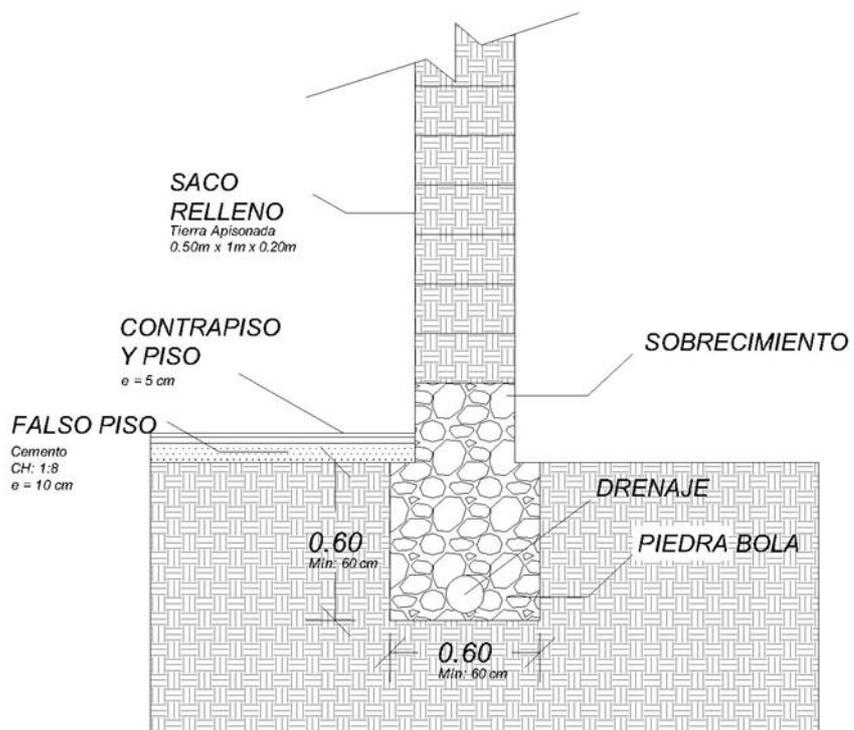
Detalle de Cimentación (Modelo con Súper Adobe).
